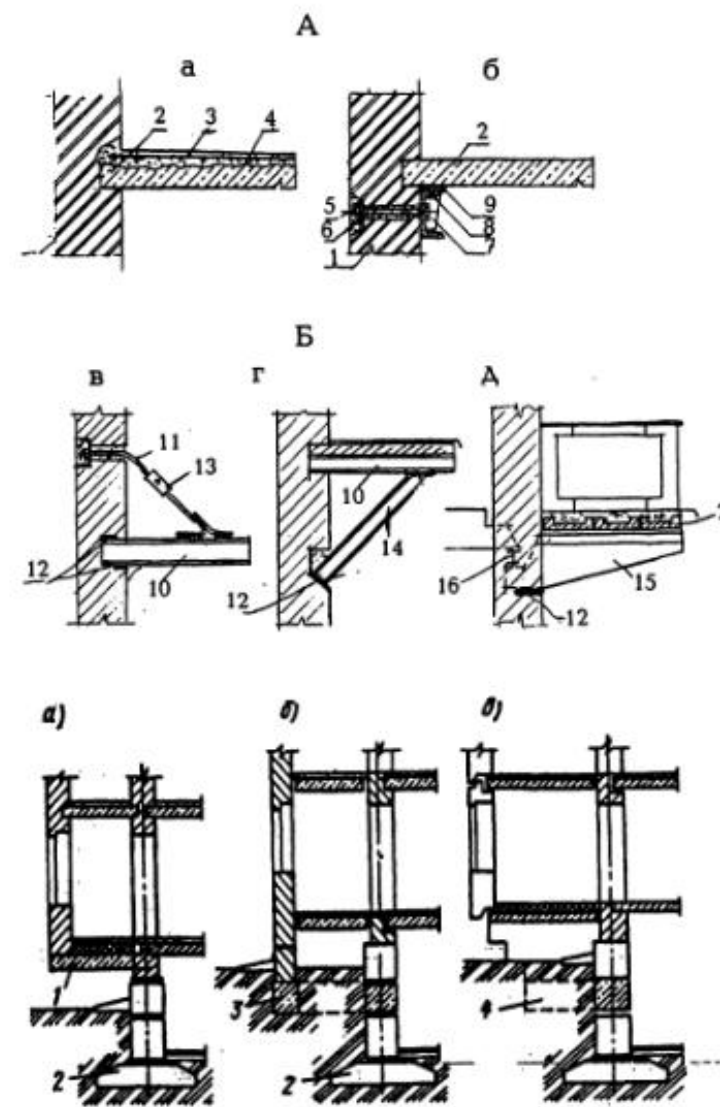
Реконструкция балконов: А - с сохранением расчетной схемы балконной плиты; Б - с заменой консольной балконной плиты на балочную; а - домонolithicиванием, б - устройством стальных опорных столиков, в - подвеской стальных консольных балок под балконную плиту, г - стальными подкосами, д - установкой железобетонных консольных балок; 1 - наружная стена, 2 - балконная плита, 3 - арматурная сетка, 4 - бетон замоноличивания, 5 - болт, 6 - пластина-шайба, 7 - ребро жесткости опорного столика, 8 - опорный столик из швеллера, 9 - стальные клинья, 10 - стальная балка, 11 - подвеска, 12 - стальная прокладка, 13 - стяжка муфты, 14 - подкос, 15 - железобетонная балка
